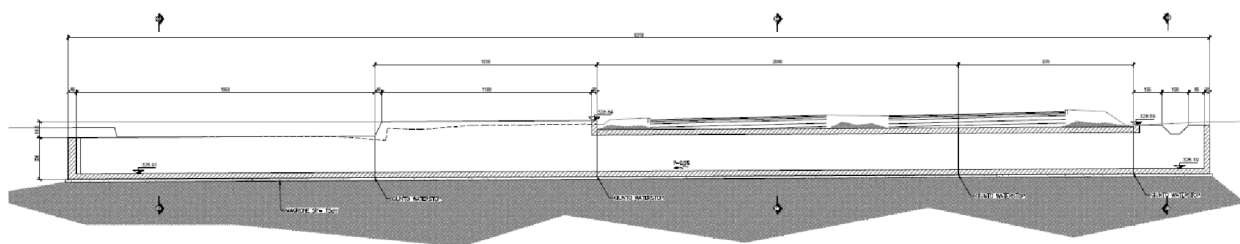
"Sezione longitudinale e rilevato stradale"
